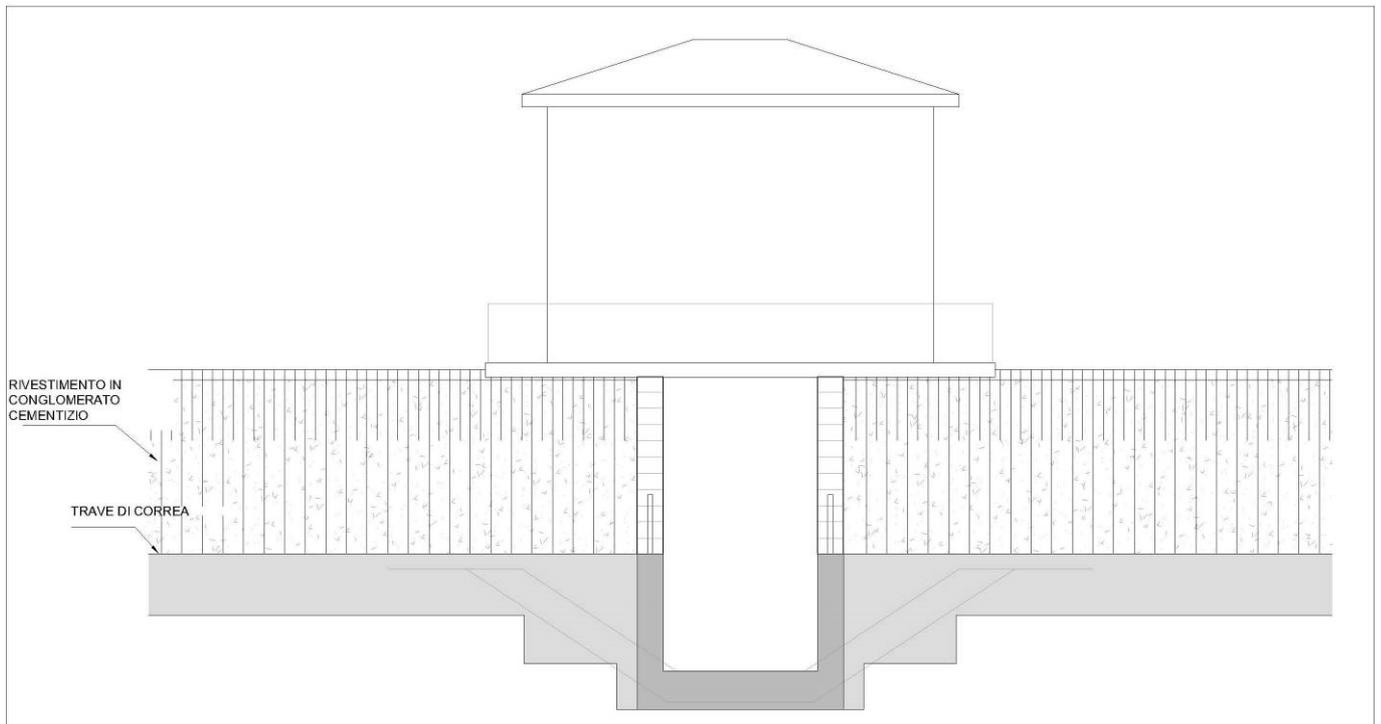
Struttura di copertura delle paratoie della chiavica sul Canale Otto Mulini prevista dal Progetto Definitivo.
